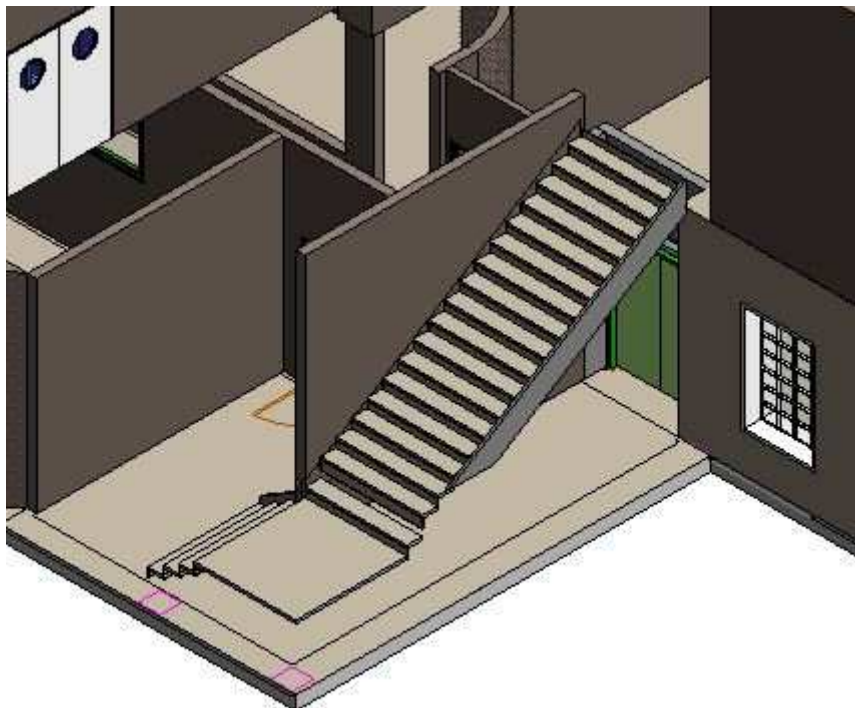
Visualización 3D escalera acceso a planta inferior (I).
